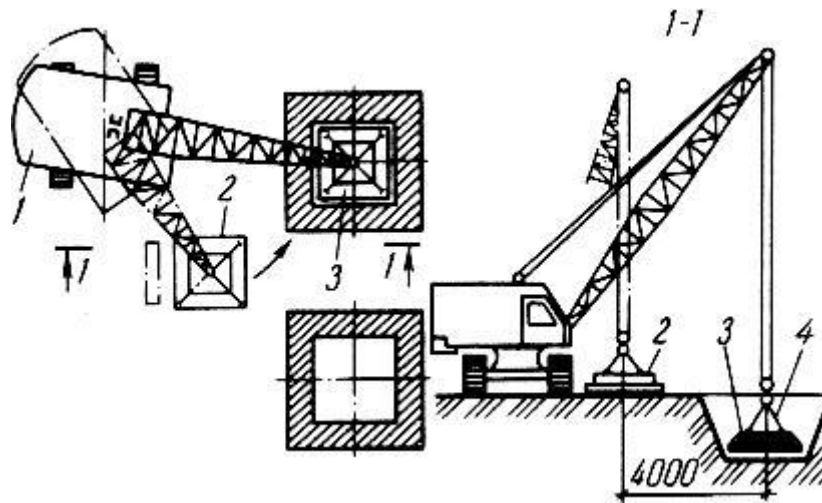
Схема монтажу стаканного фундаменту стріловим краном
